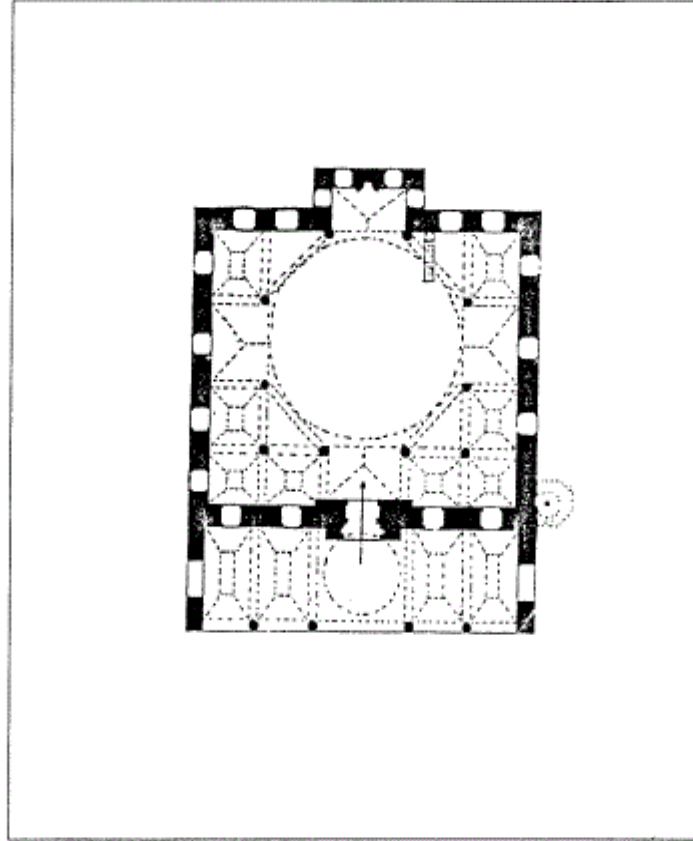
مسقط أفقي لمسجد عتيق علي باشا في دنجري قويو باستانبول
